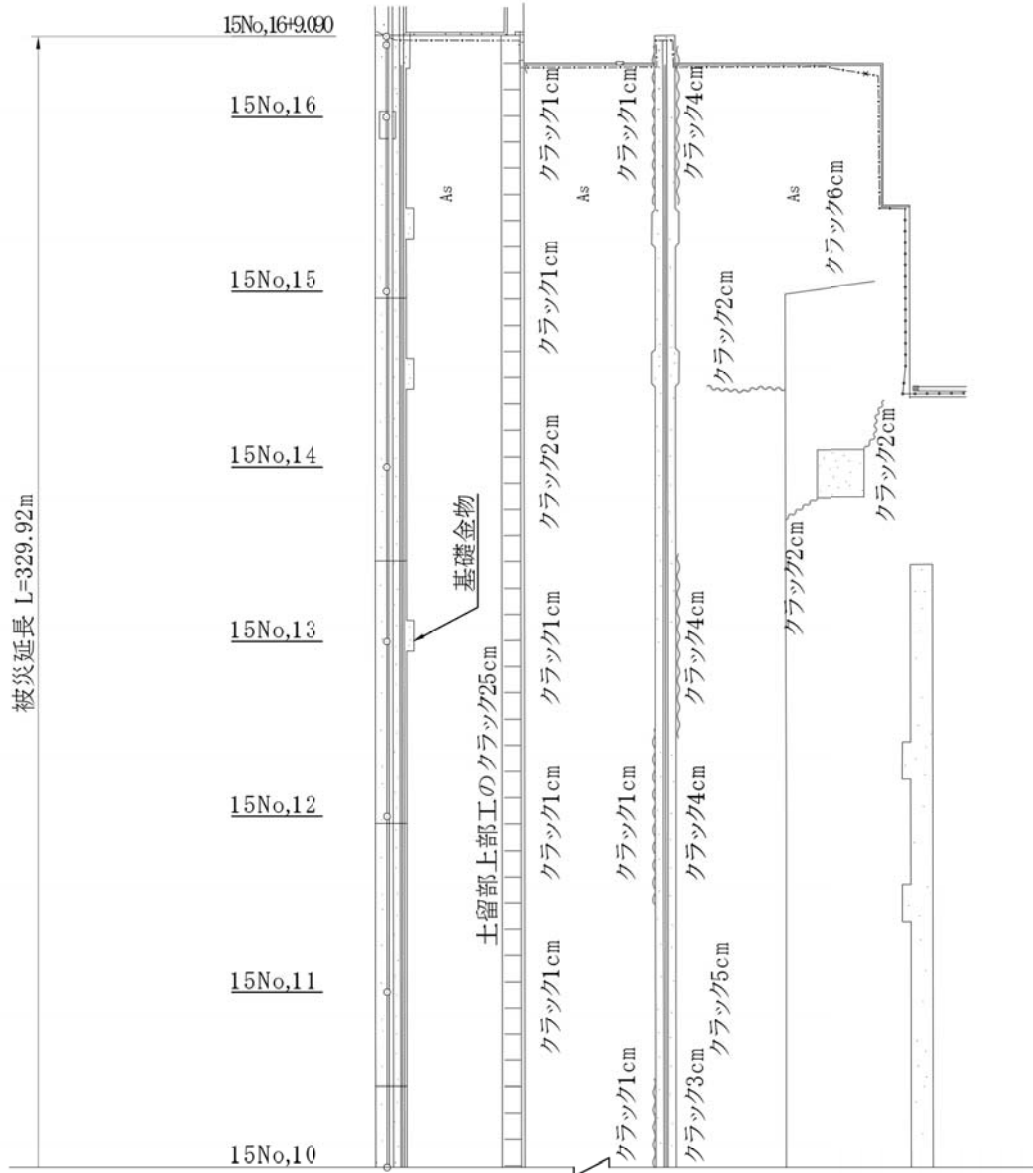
(b) アイランドシテイ地区-1.4m 栈橋の被災状況平面図②
